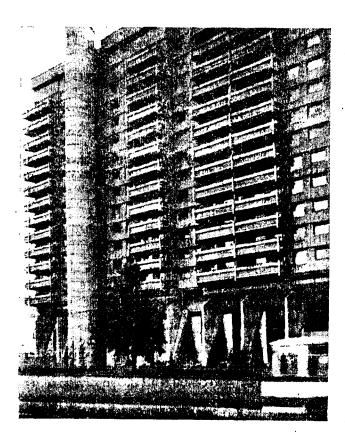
Москва. Фрагмент фасада жилого дома с различной отделкой несущих элементов и испесущих наружных стен
